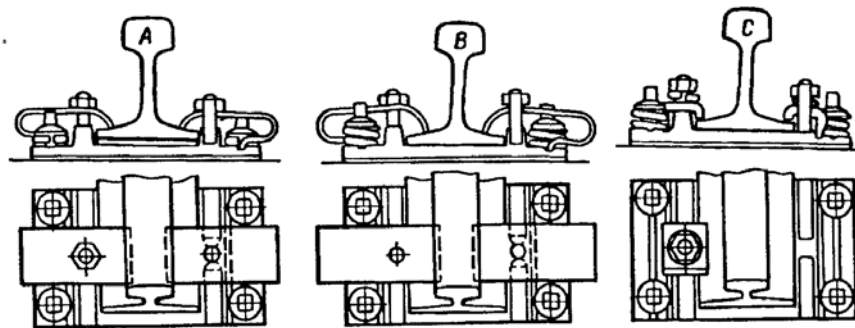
Скрепления, предназначенные для укладки на мостах без балласта
